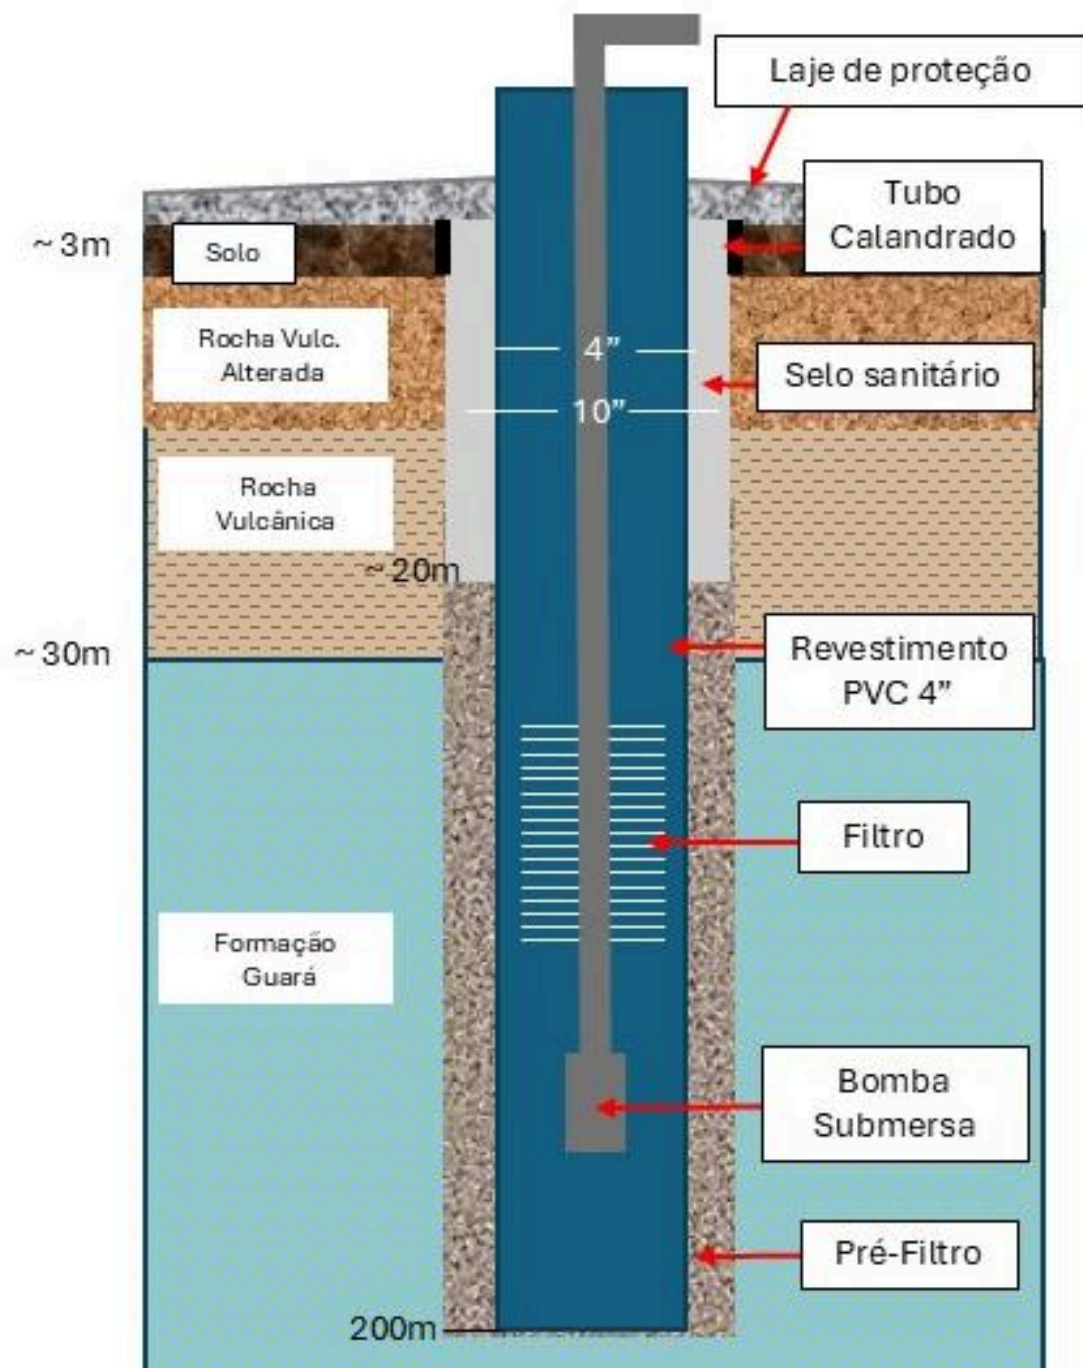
Perfil Geológico-constructivo esquemático do poço tubular.
